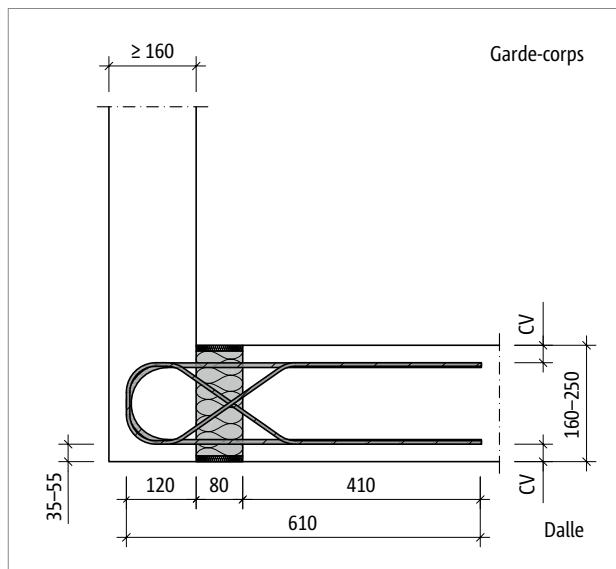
Schöck Isokorb® T type A : coupe du produit
